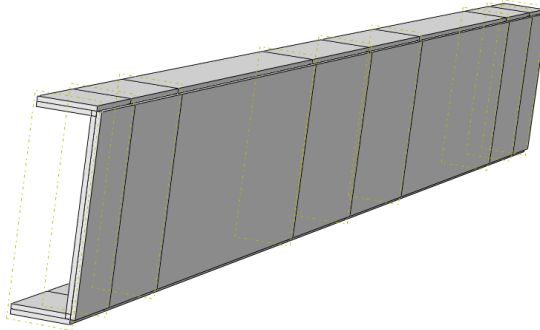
Abaqus Programı Assembly Modellemesi
